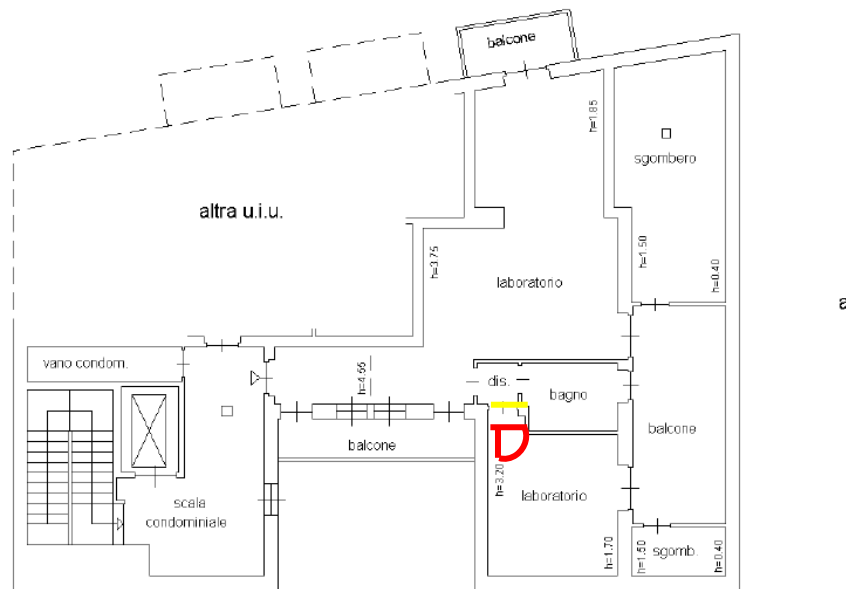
Stralcio planimetria catastale piano secondo f. 1, part. 1665, sub. 10 lotto 4.
